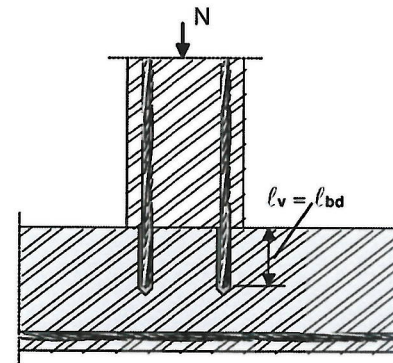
Bewehrungsanschluss überwiegend auf Druck beanspruchter Bauteile. Die Bewehrungsstäbe werden auf Druck beansprucht.
